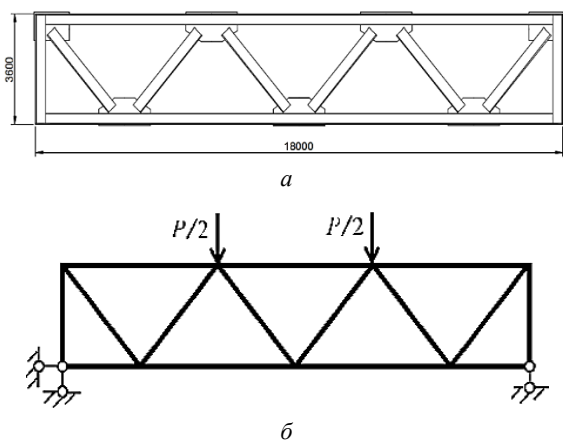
Графічна схема ферми: а) схема решітки ферми; б) схема навантаження ферми
